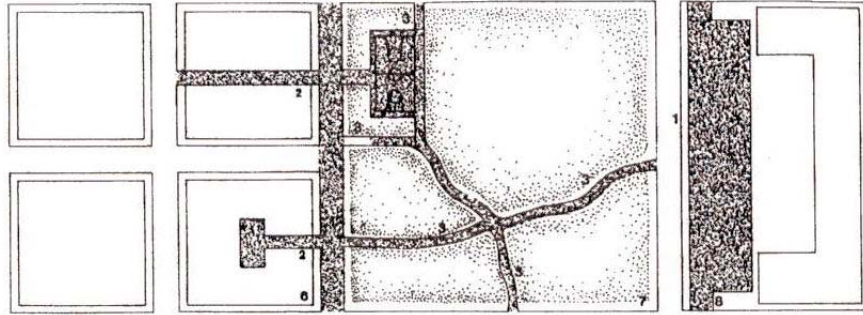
1.- Estacionamientos, 2.- Pasajes, 3.- Veredas o ciclovías y senderos 4.- Canchas de uso múltiple, 5.- Calles de bajo tránsito, 6.- Manzanas de la zona urbanizada, 7.- Áreas verdes, 8.- Sector comercial.
